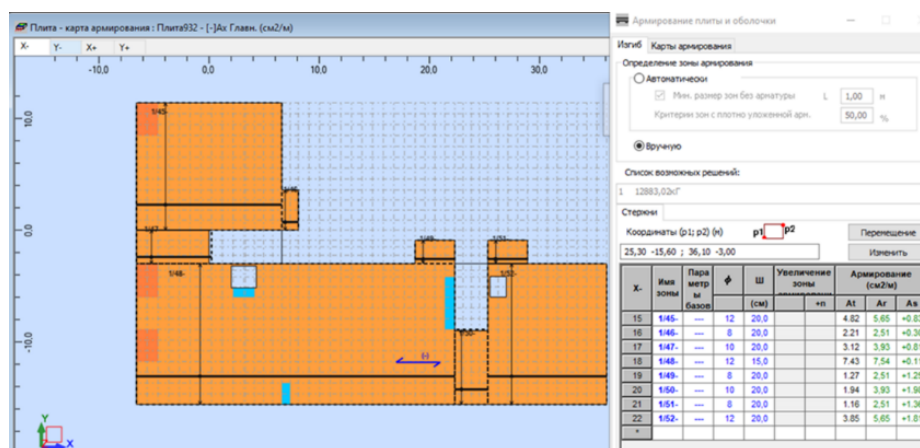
Нижнее армирование плиты по оси X в ПК RSA
